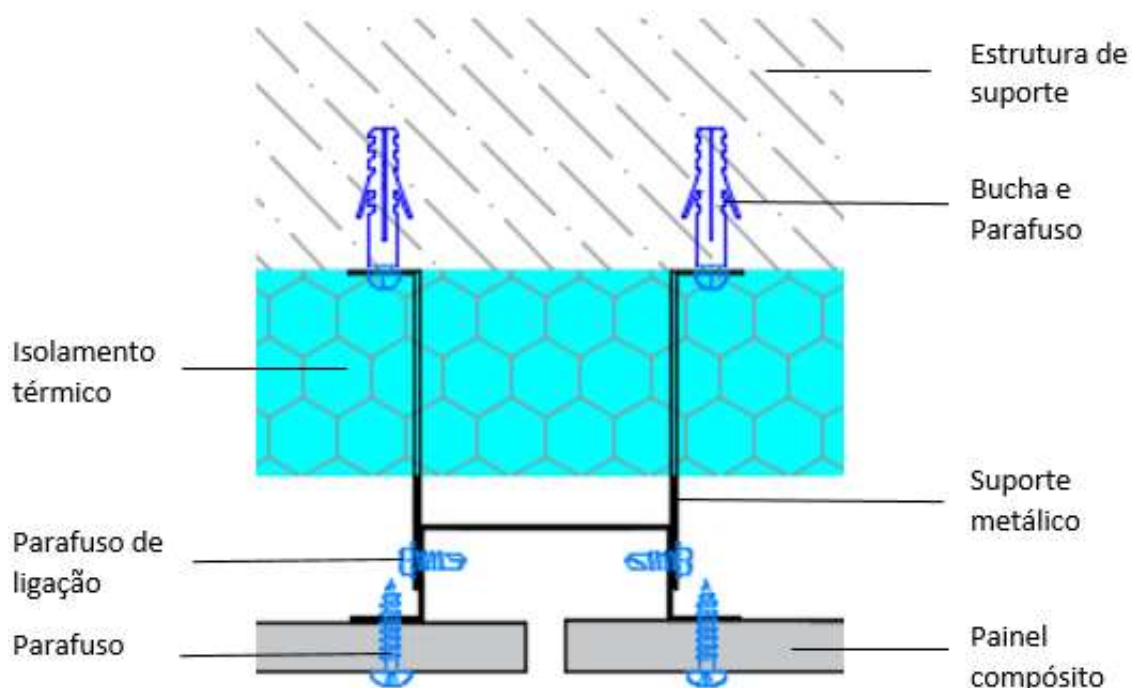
Seção horizontal na aplicação em fachadas ventiladas
